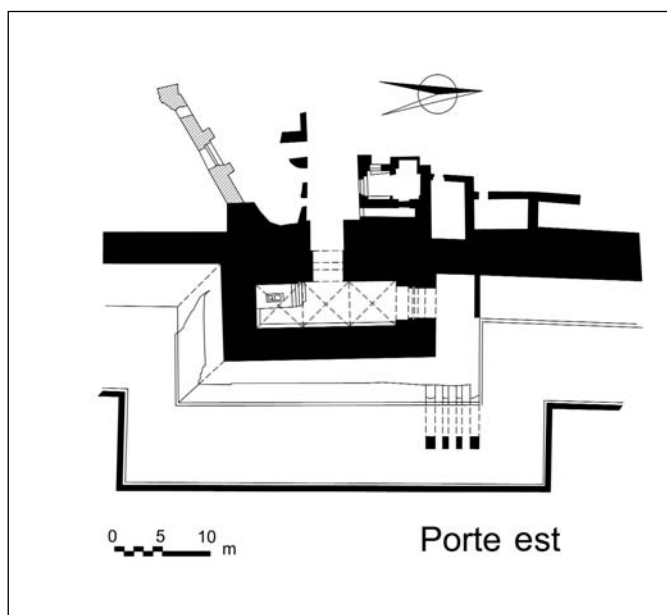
Césarée, plan de la porte est, d'après A. Negev.
